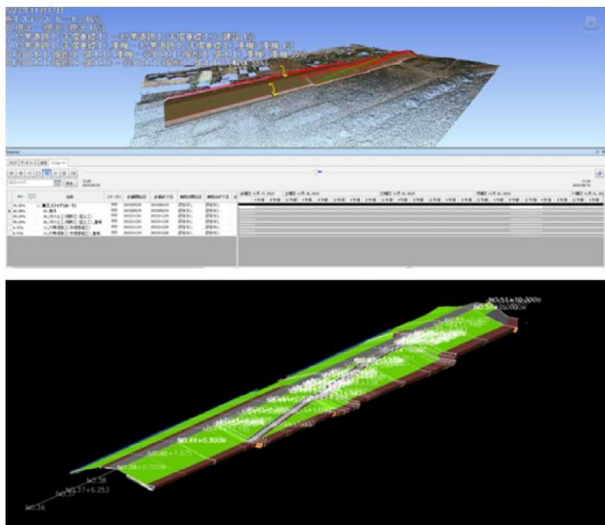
(参考画像)BIM/CIMモデルを活用した施工ステップの確認
